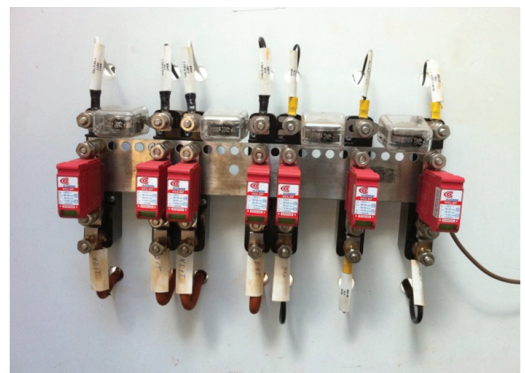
DPS conectados ao plano equipotencial de baixa impedância.
